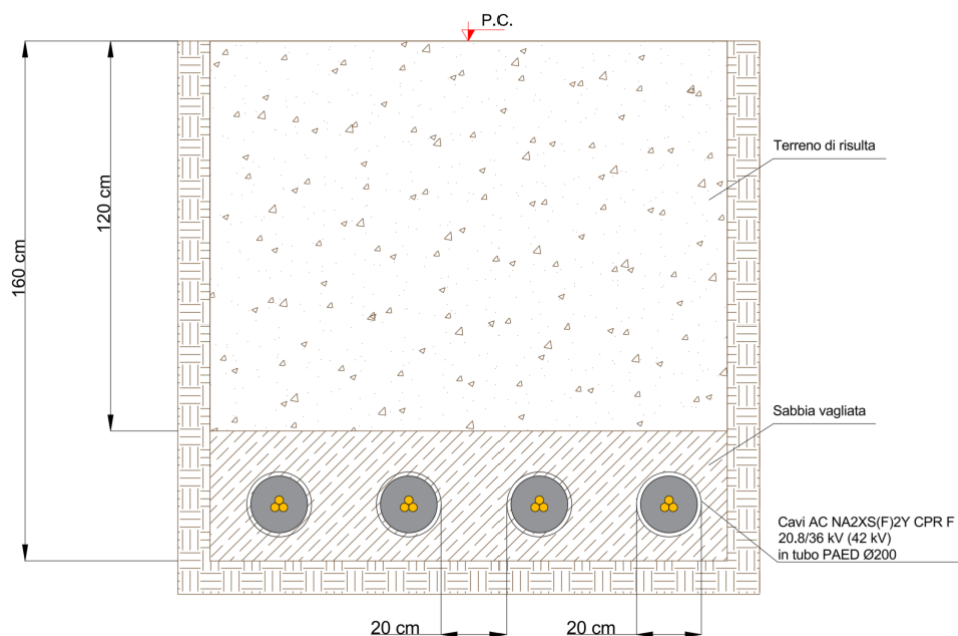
Sezione di posa per cavidotto 36 kV di collegamento tra impianto agrivoltaico e Stazione Elettrica
